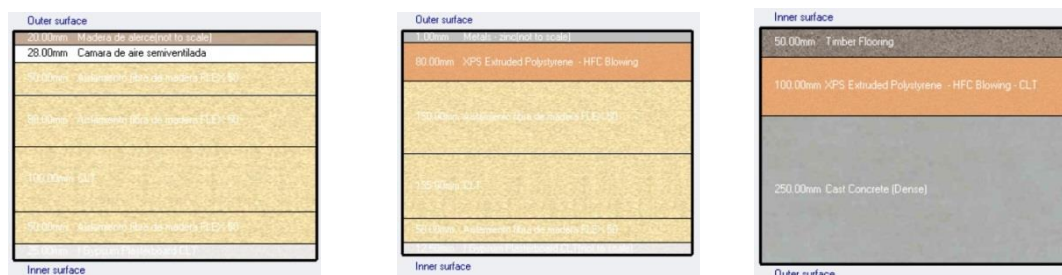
Sistema constructivo envolvente (Fachadas, Cubierta y Forjado). Fuente: Elaboración Propia
